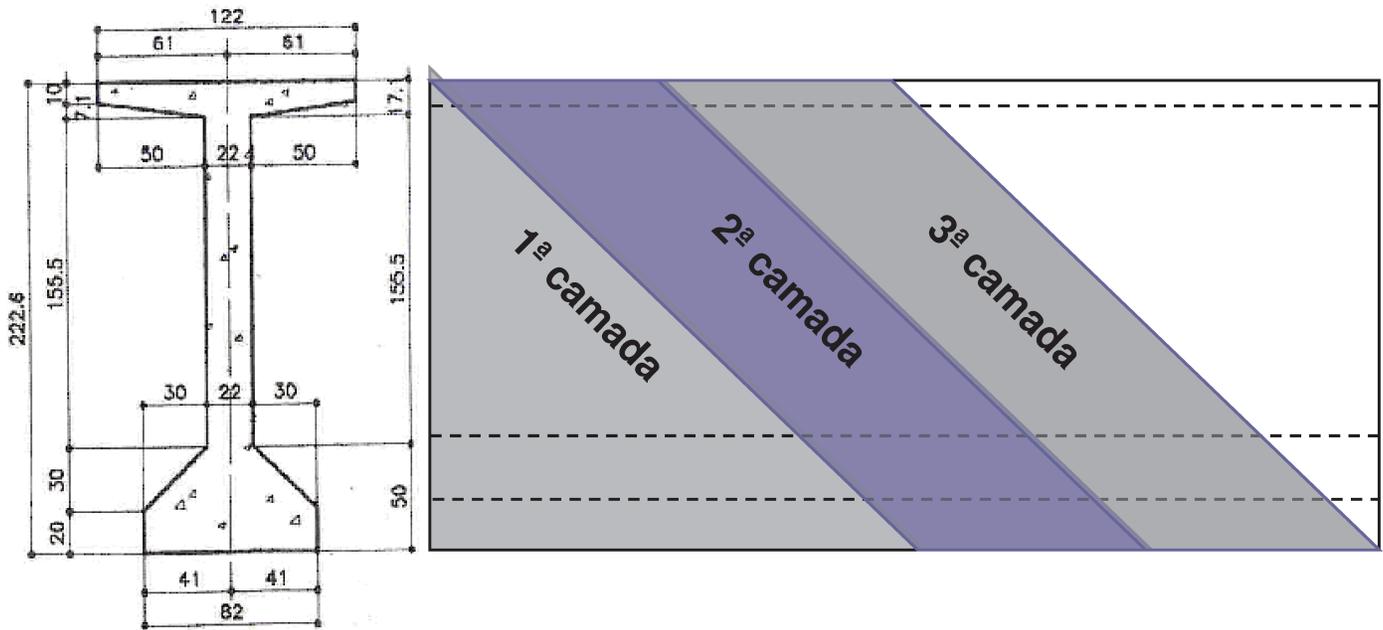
Croqui do Plano de Concretagem (Arquivo Próprio)
